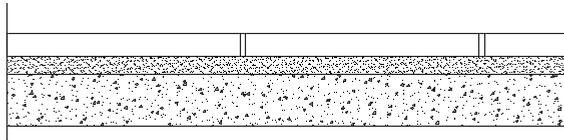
Detalle pavimento. Fuente: Propia de la autora
